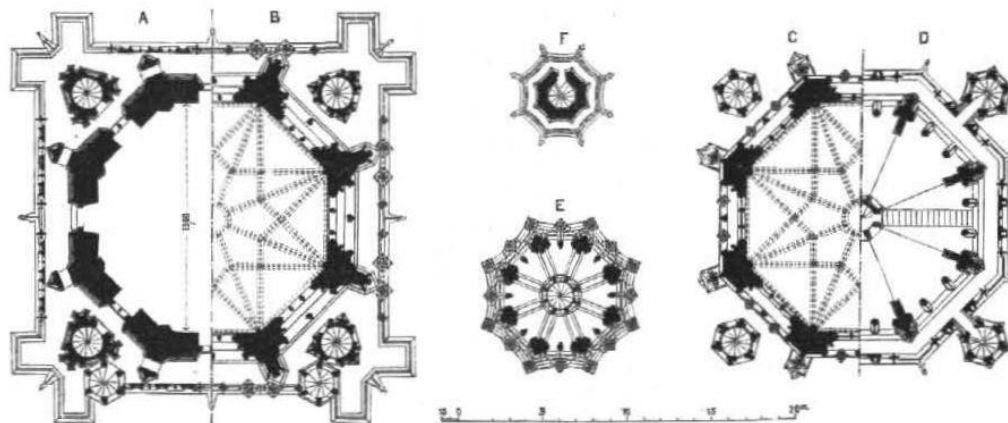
9. Grundrisse vom Achteck und Helm.
